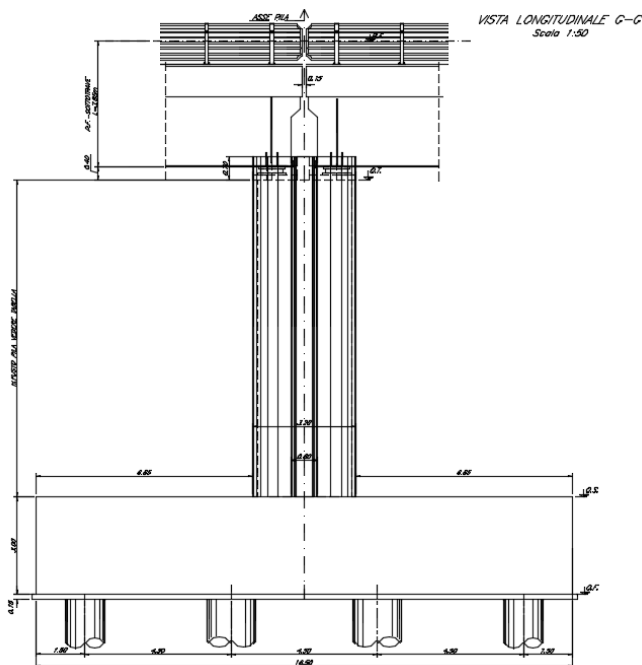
Prospetto Pila P02 - P05 -sezione longitudinale
